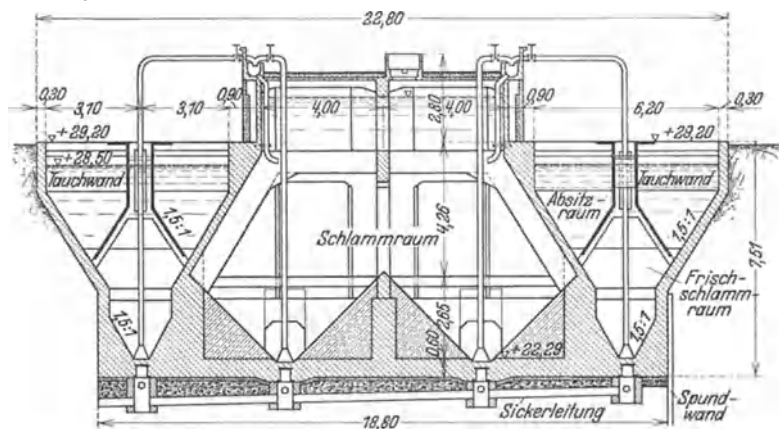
Absatzraum und Schlammfallraum nebeneinander (nach Prüß).
